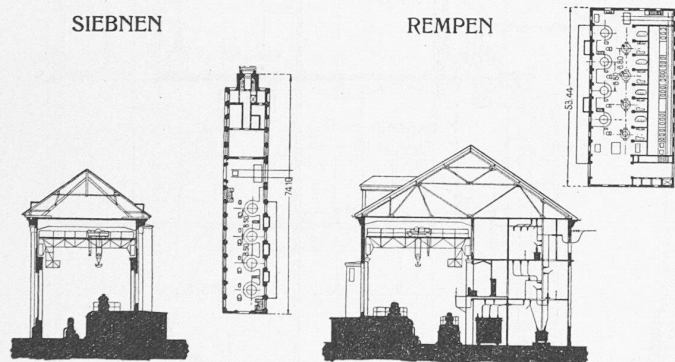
Vergleich der Querschnitte der Maschinenhäuser Siebnen und Rempen.
